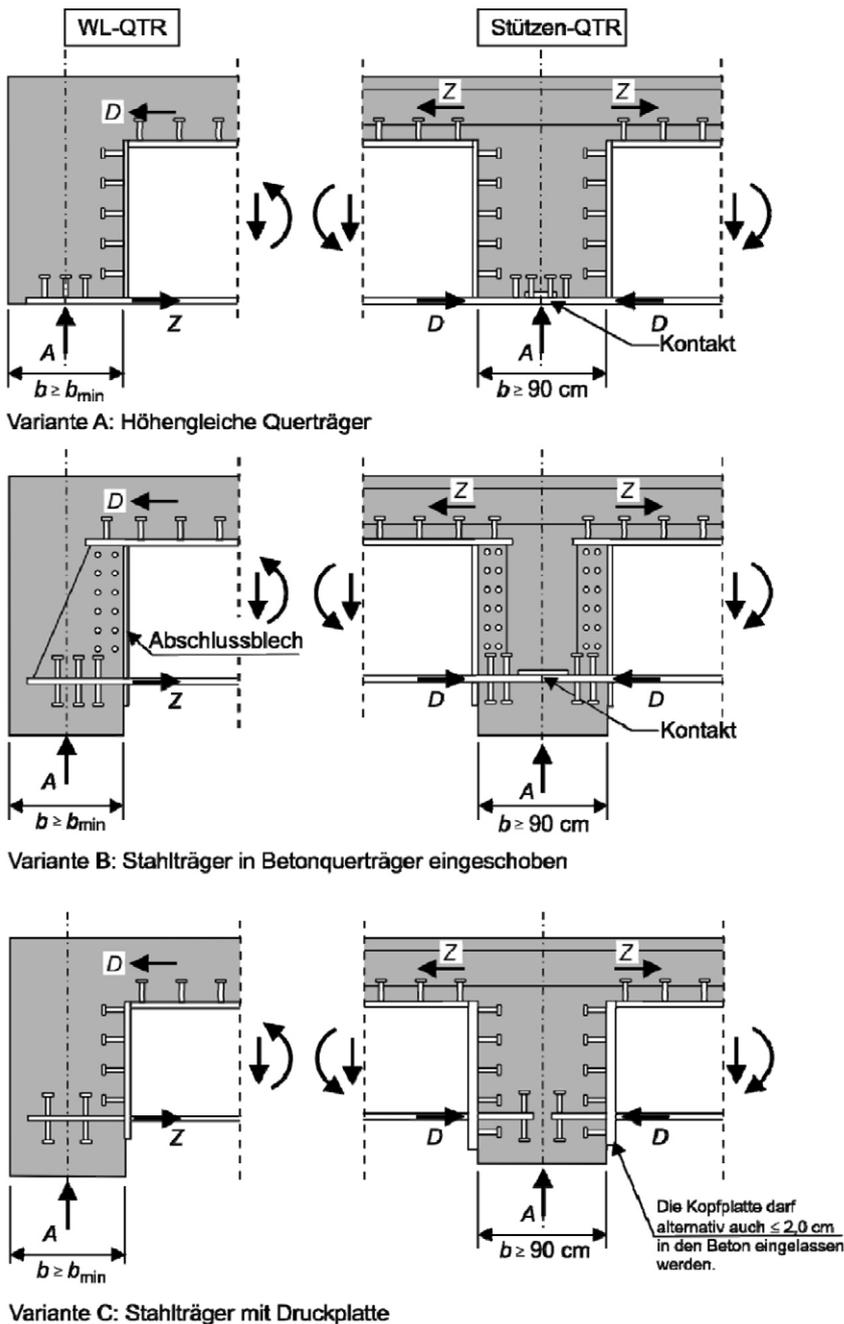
Varianten zur konstruktiven Durchbildung der Stahlbetonquerträger. Aus ZTV-ING Teil 4, Abschnitt 2, Anhang A
